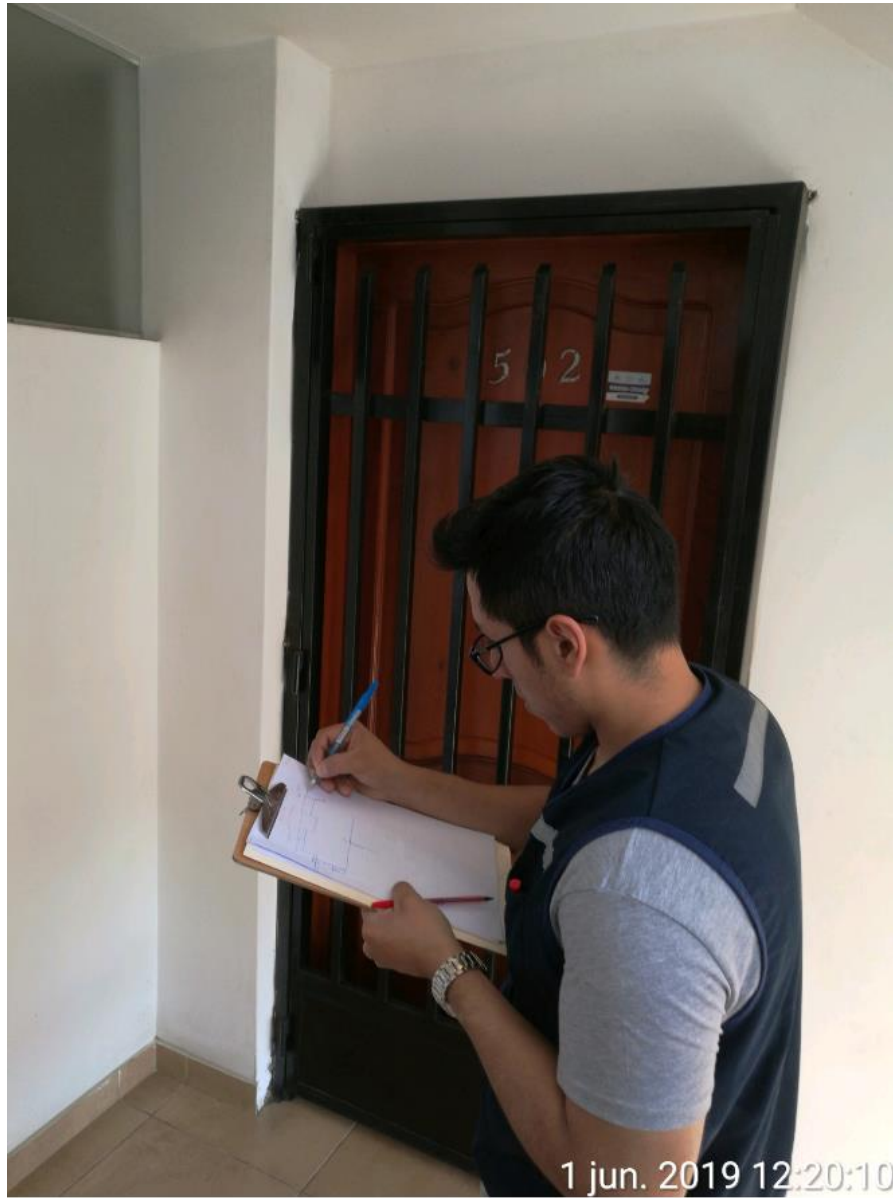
Levantamiento Arquitectónico en Azotea.
